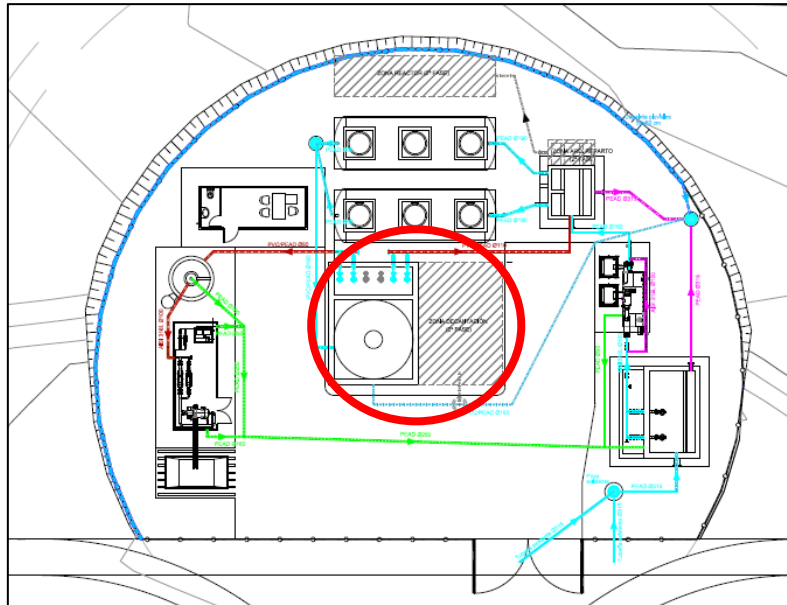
plano de la E.D.A.R.i con la modificación del decantador diseñado marcado en rojo
